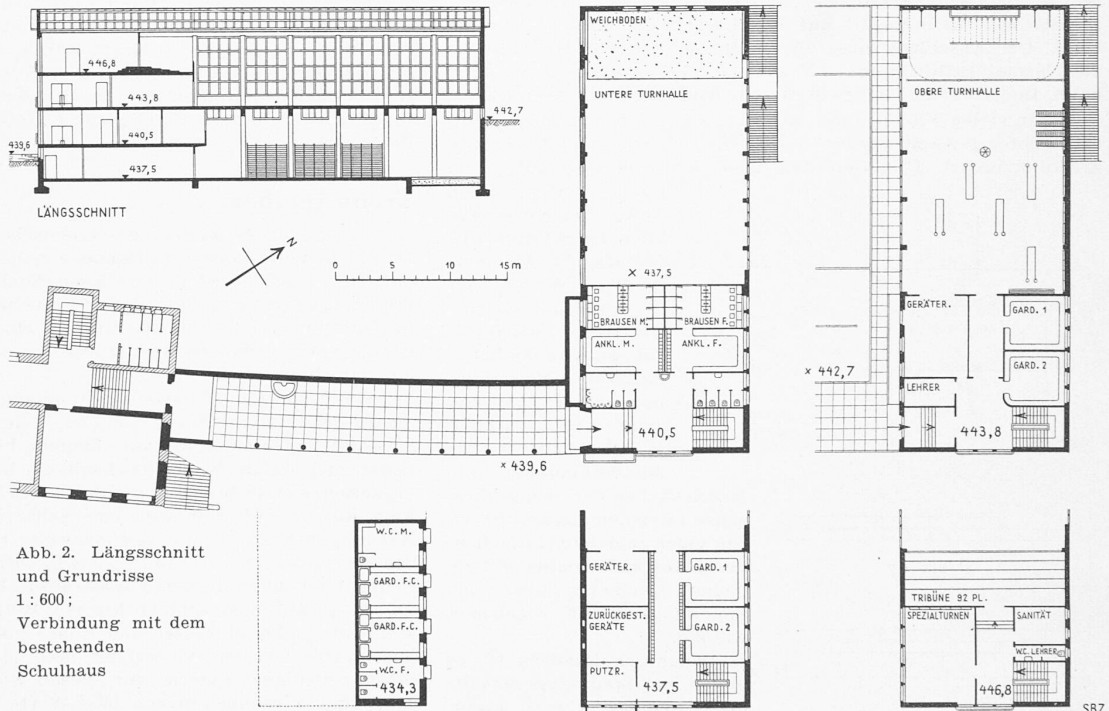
Längsschnitt und Grundrisse 1 : 600; Verbindung mit dem bestehenden Schulhaus
